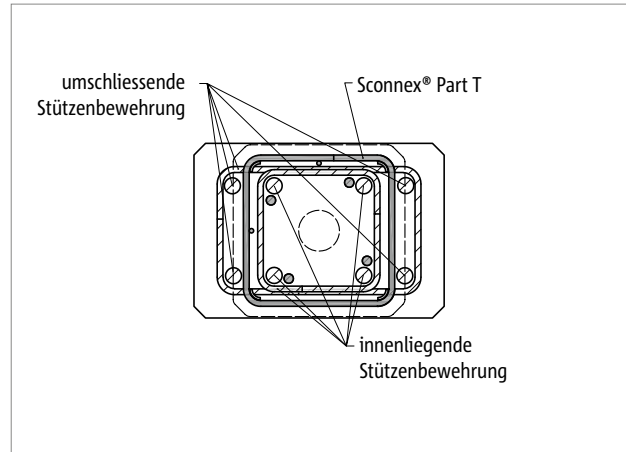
Schöck Sconnex® Typ P: Bewehrungsführung im Bereich 3 – Stützenquerschnitt
